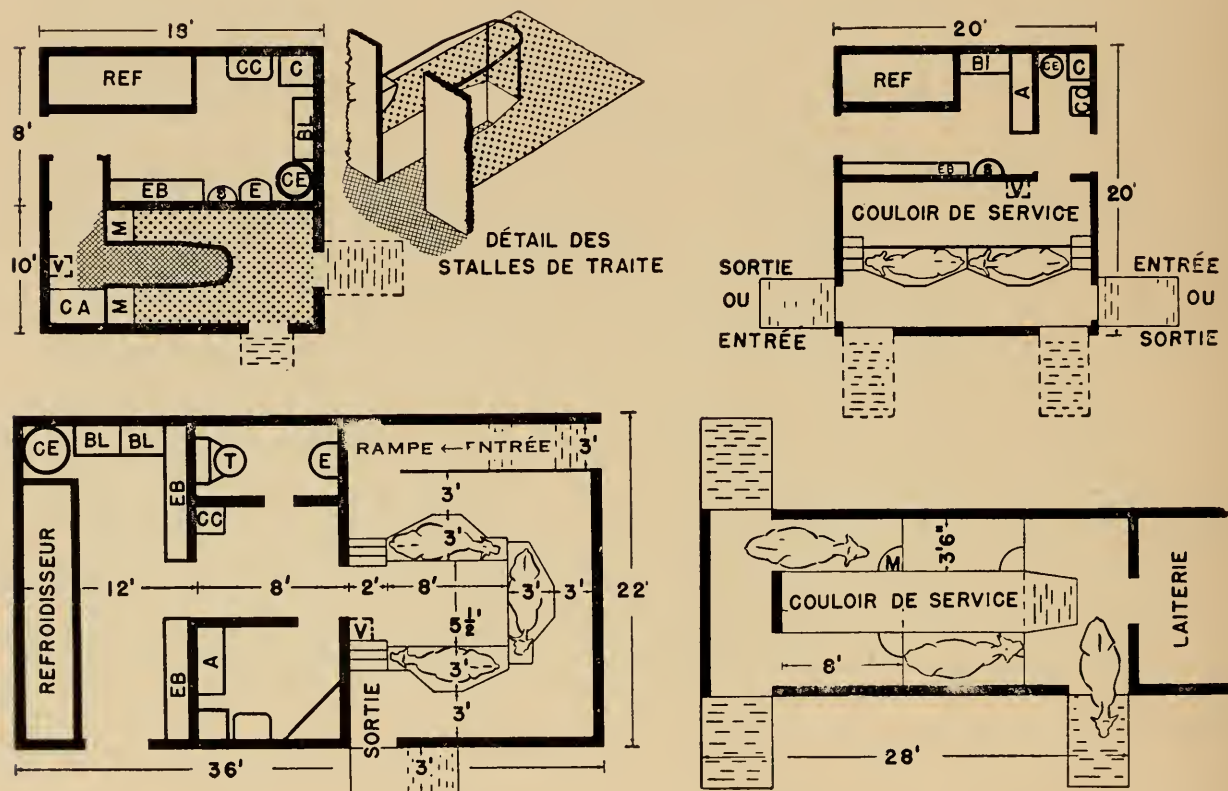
La salle de traite à sortie à reculons (en haut, à gauche) convient aux troupeaux de 6 à 16 vaches. Les stalles du type barrière, à entrée latérale, (en haut, à droite) se disposent par rangées de 2, 3 ou 4 stalles. La disposition en U (en bas, à gauche) comporte 3 à 5 stalles. Les stalles à circulation à sens unique (extrémité inférieure droite) peuvent s'employer pour une salle renfermant 2 ou 4 stalles. Des laiteries de divers modèles peuvent servir avec n'importe quel plan de salle de traite. Légende: C—cheminée; A—armoire; EB—égouttoir à bidons; E—évier; M—mangeoire; CC—chaufferette de la chambre; S—stérilisateur à gobelets trayeurs; T—toilette; V—ventilateur ou conduit d'aération; CE—chauffe-eau; BL—bacs (cuves) de lavage; CA—Coffre à aliments.
